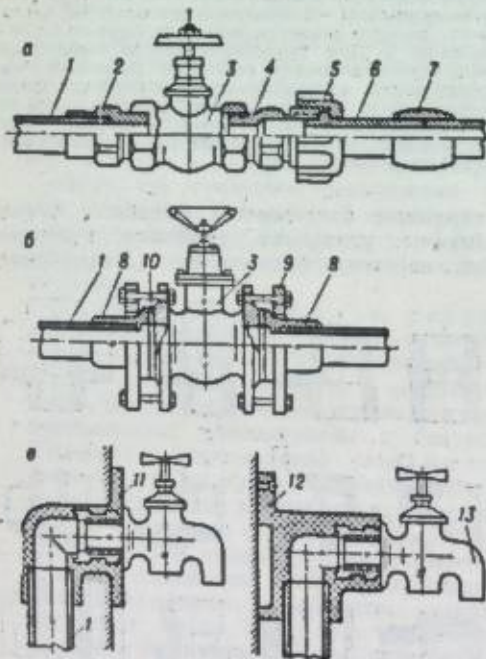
Соединение пластмассовых труб с металлической арматурой: а — с резьбовым вентиляем; б — с фланцевым вентиляем; в — с краевым; 1 — труба; 2 — футорка пластмассовая; 3 — вентиль; 4 — nipple пластмассовый; 5 — накидная гайка; 6 — втулка бортовая; 7 — муфта; 8 — втулка под фланец; 9 — фланец; 10 — прокладка; 11 — угольник с крепежным фланцем, тип А, для скрытой проводки; 12 — угольник с крепежным фланцем, тип Б, для открытой проводки; 13 — край.
